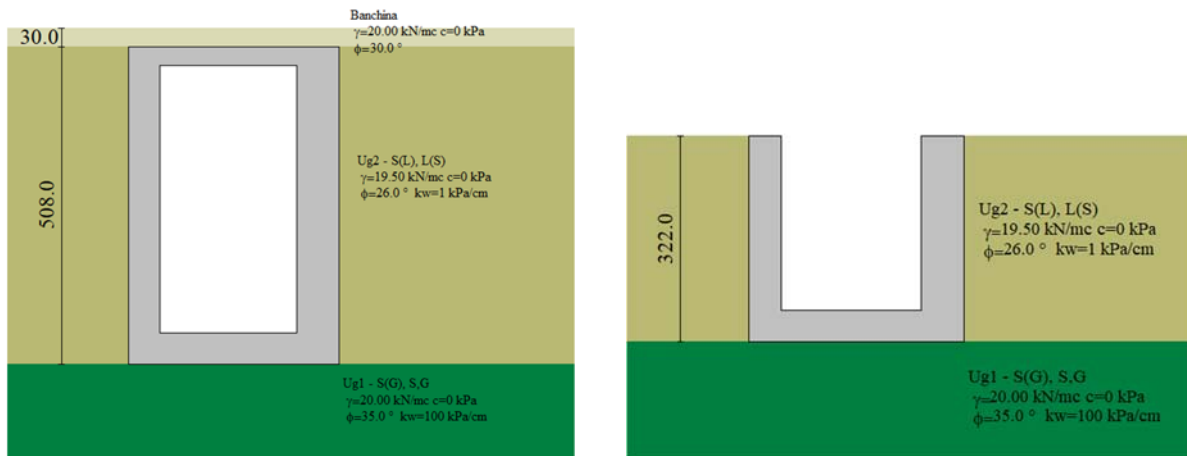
Modelli di calcolo struttura rampa scale: Sezione di calcolo A (sx) e Sezione di calcolo B (dx)
